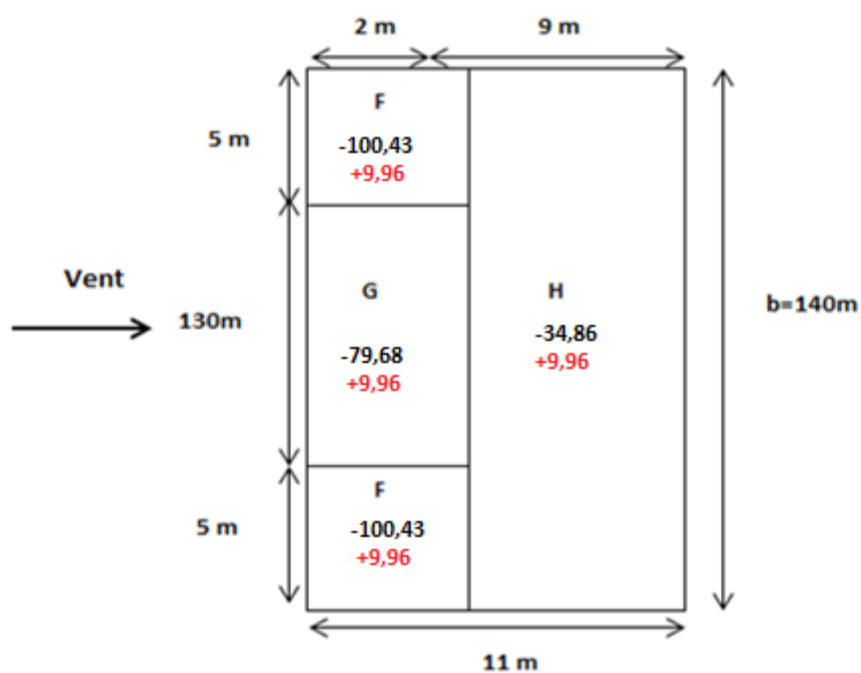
Pressions sur la toiture versant 1 directions du vent (V2,V4) [daN/m²].
